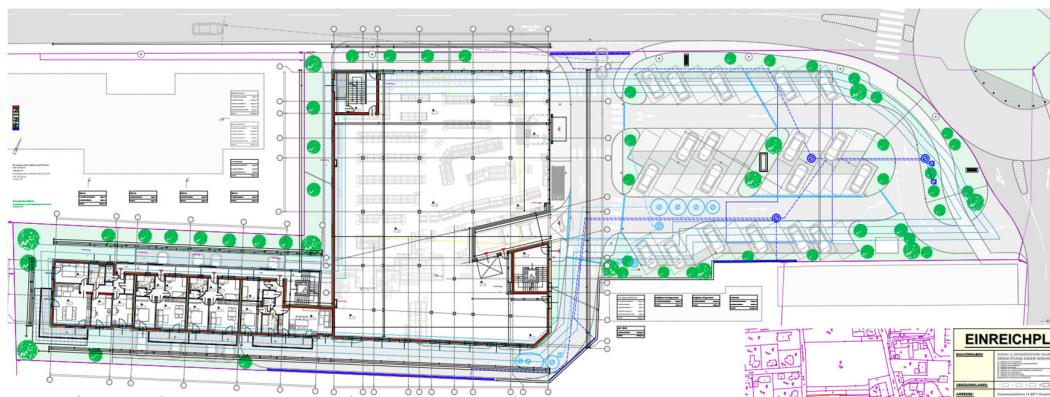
Einreichprojekt „Wohn- & Gewerbepark Hausmannstätten, Errichtung einer Wohnhausanlage“, verfasst vom Planungsbüro Mittendrein GmbH vom 22.12.2025, Projekt Nr.: M407, HMS14, übermittelt vom Planungsbüro Mittendrein GmbH per Mail, am 08.01.2026
